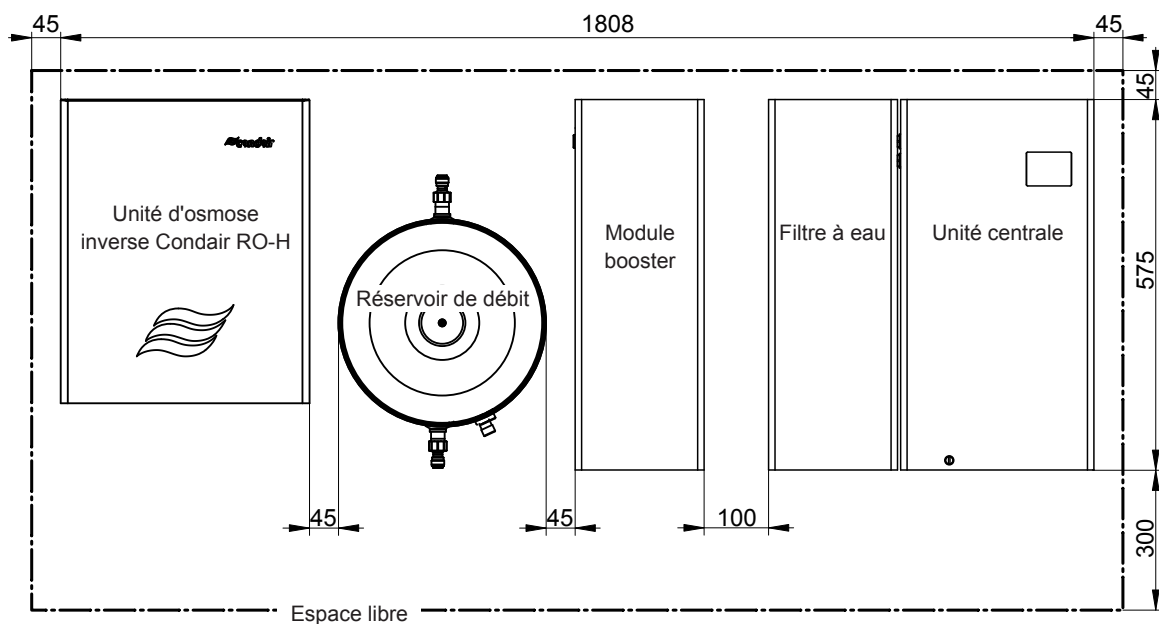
Exemple de placement 1 (dimensions en mm)
